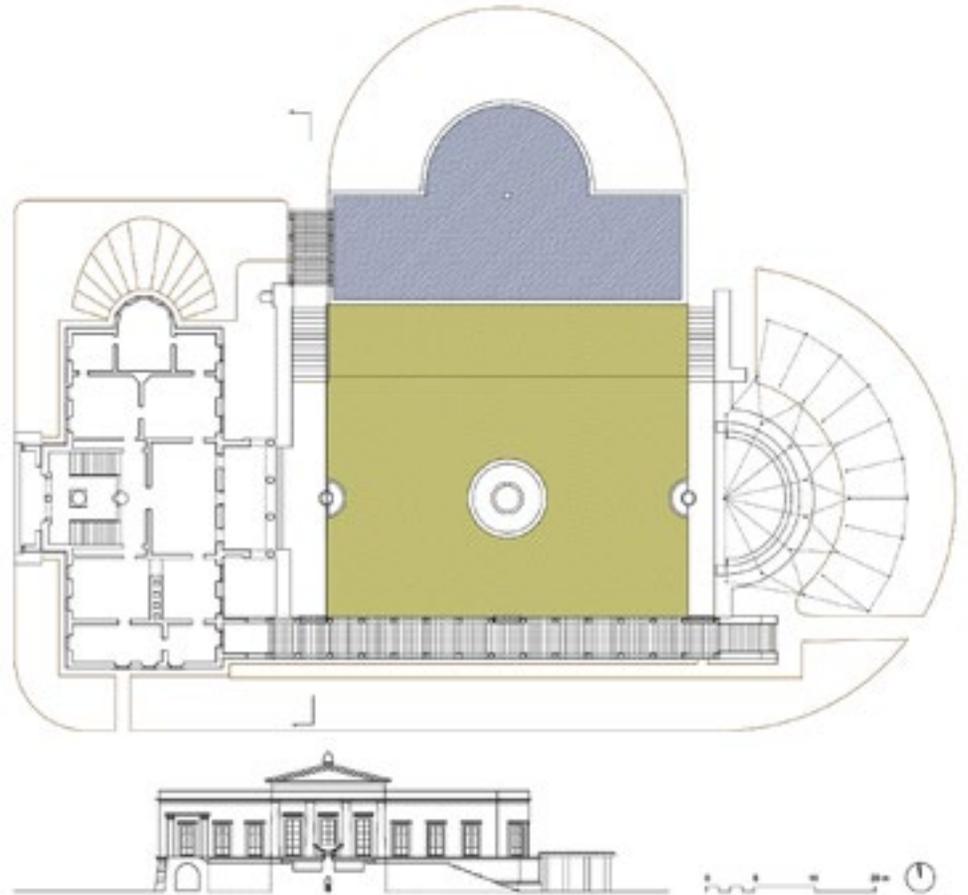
Planta primera y sección del palacio de Charlottenhof. Muro exterior y pérgola frente al acceso sur.
